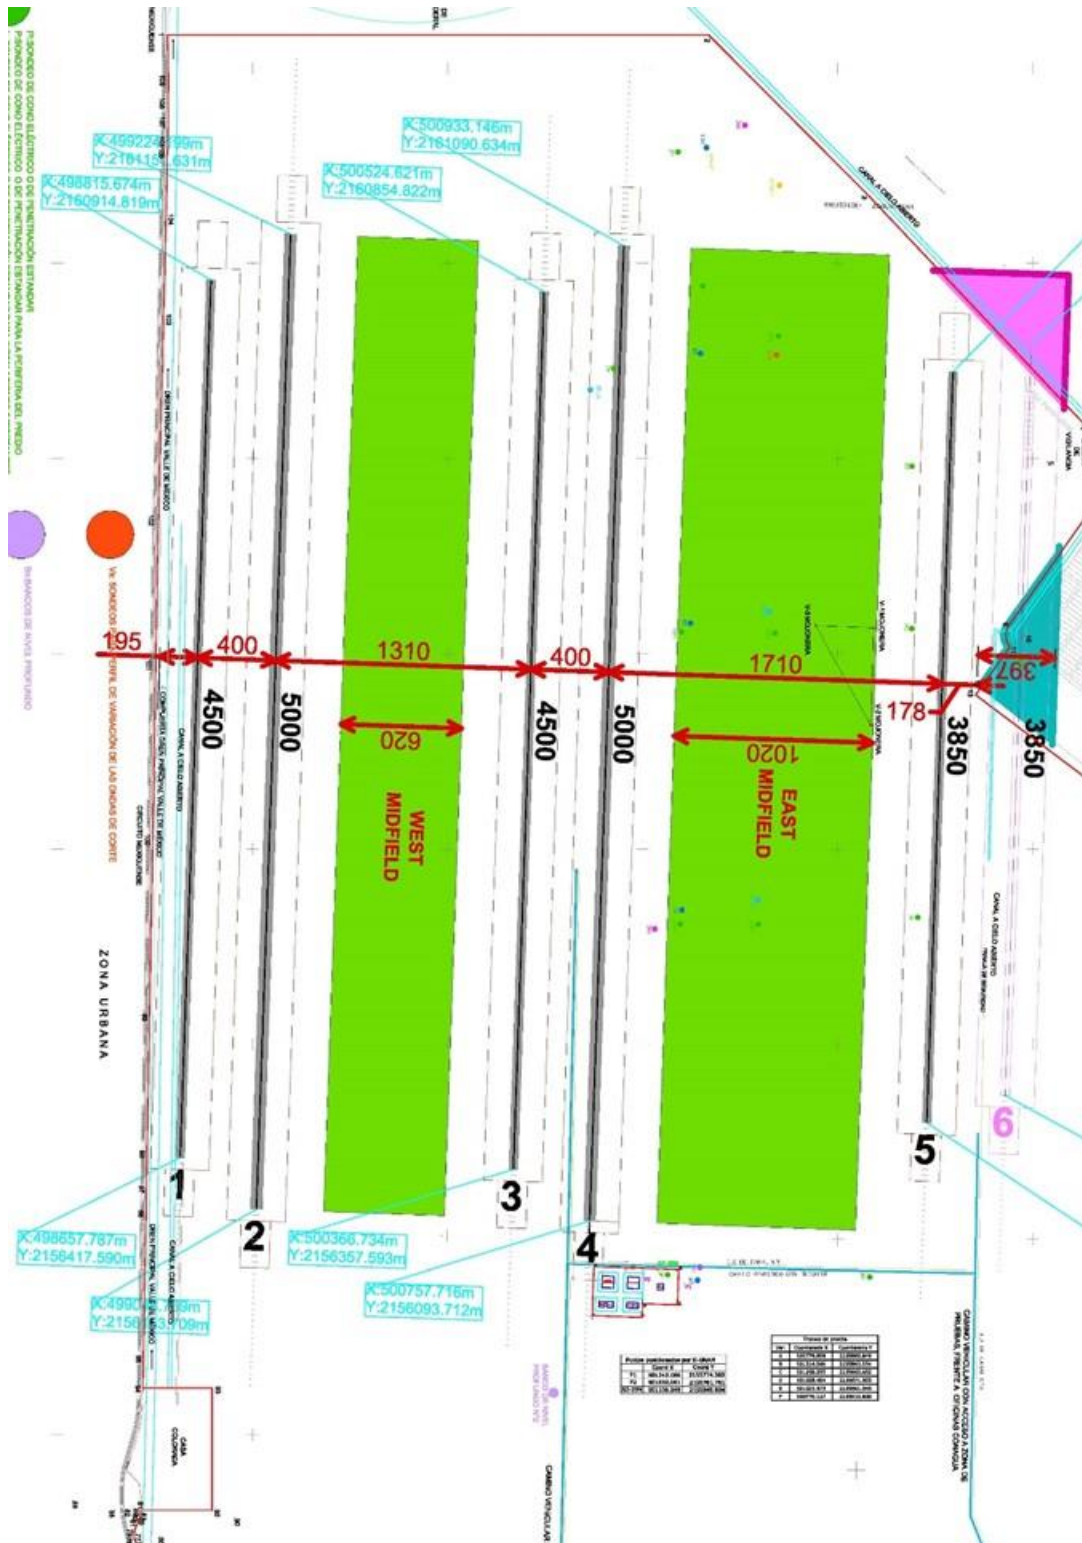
k.1 Ubicación de los tramos de prueba en la planta general
